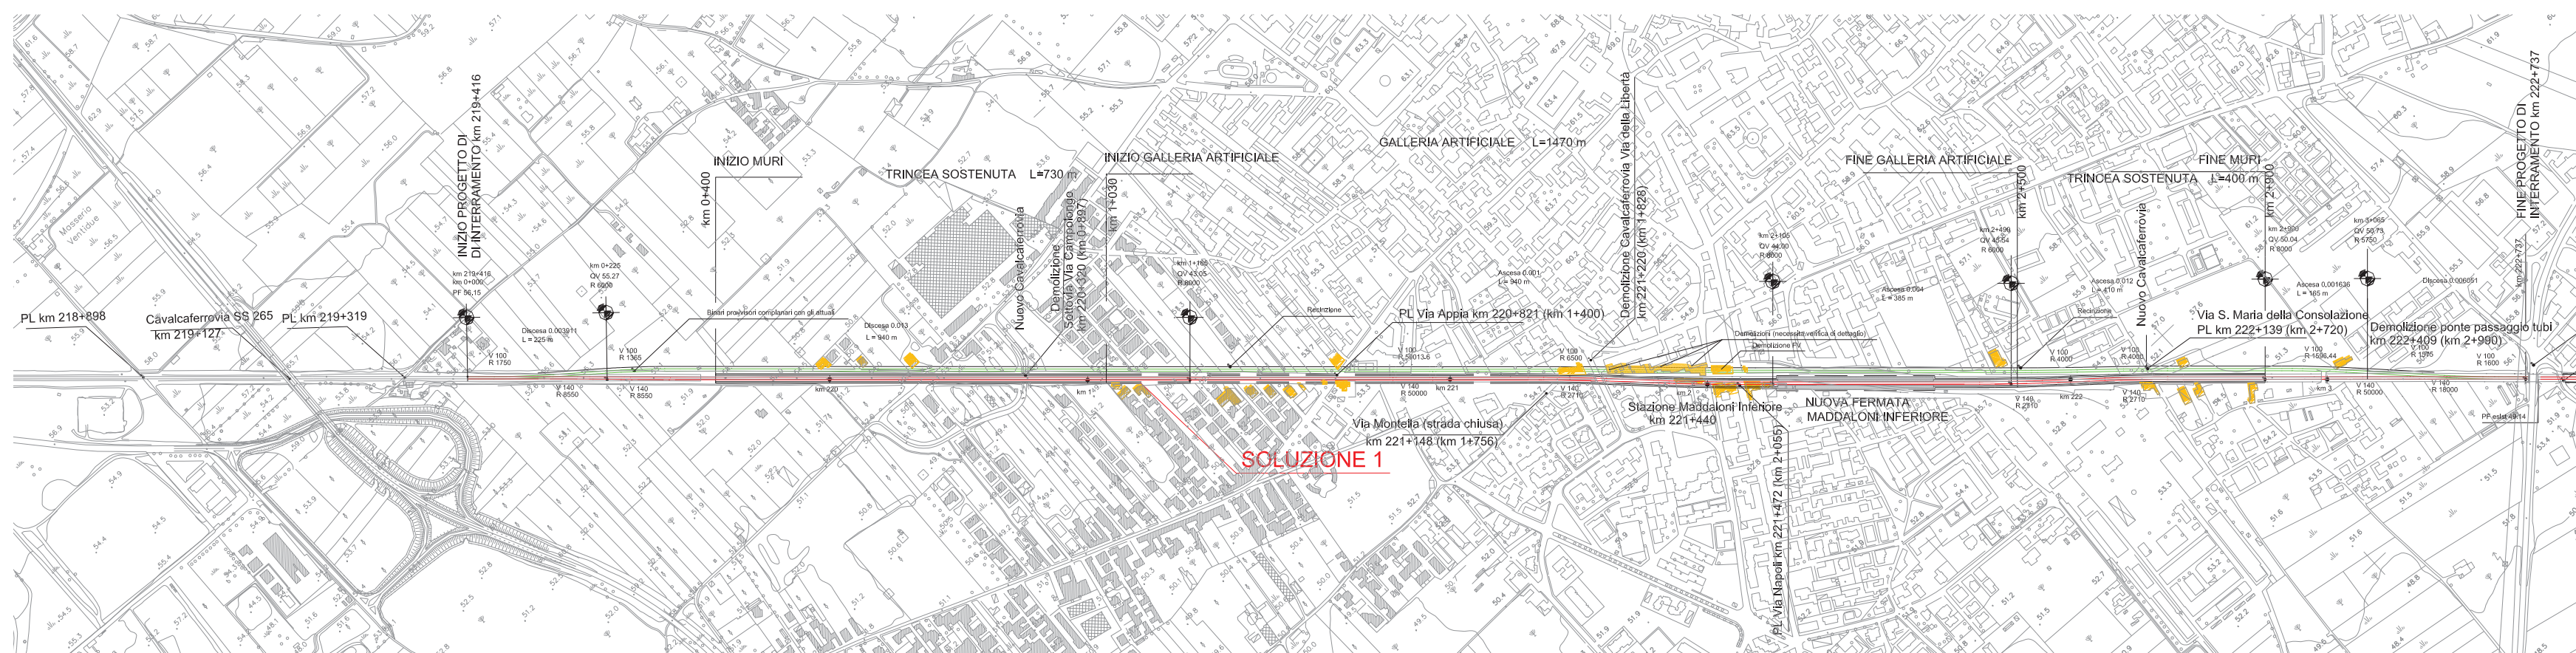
PROGETTO DI INTERRAMENTO SOLUZIONE 1: PLANO-PROFILO
